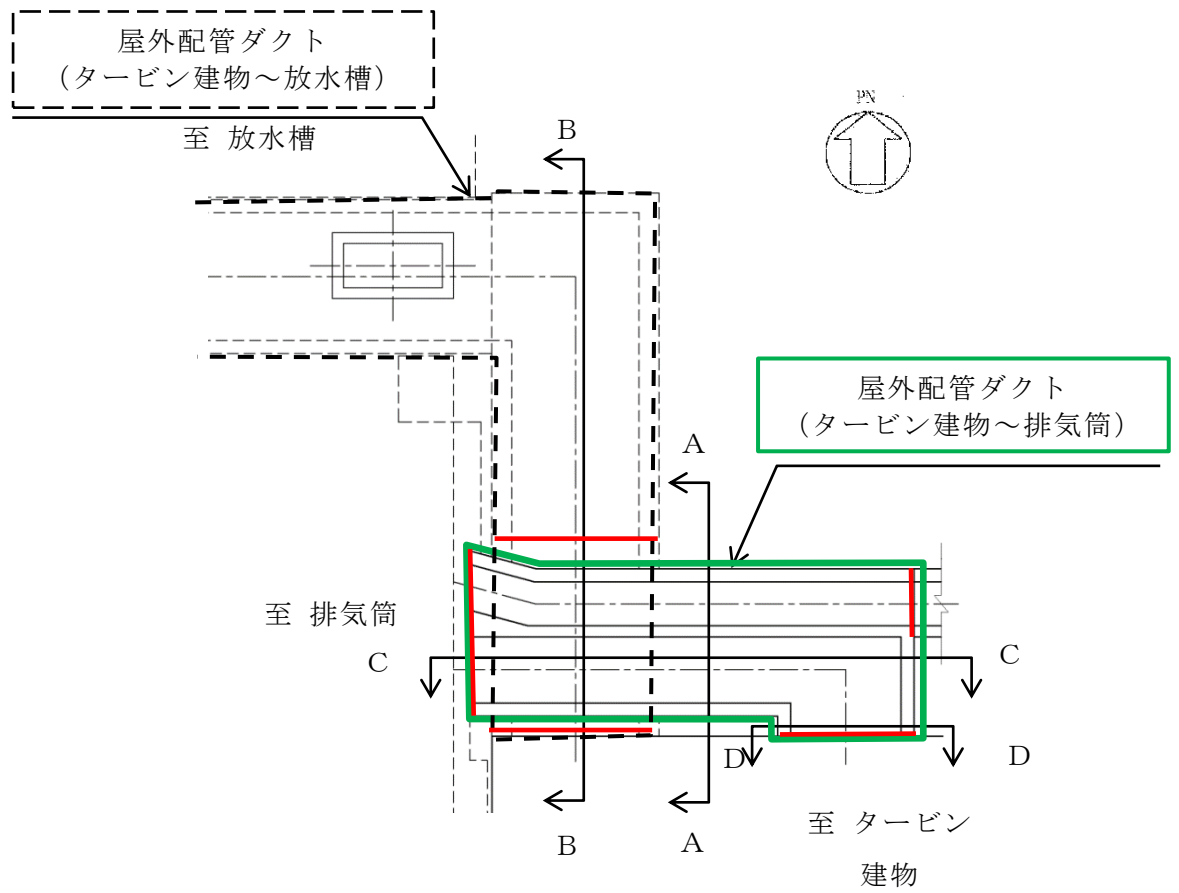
屋外配管ダクト (タービン建物～排気筒) 平面図
